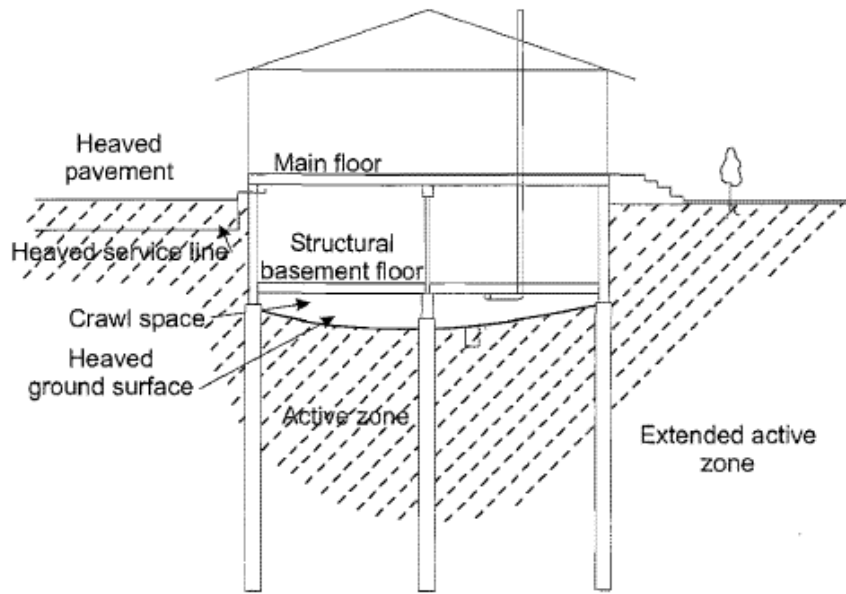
Ilustración de una losa de piso estructural y de pilote corto debajo de una estructura liviana
